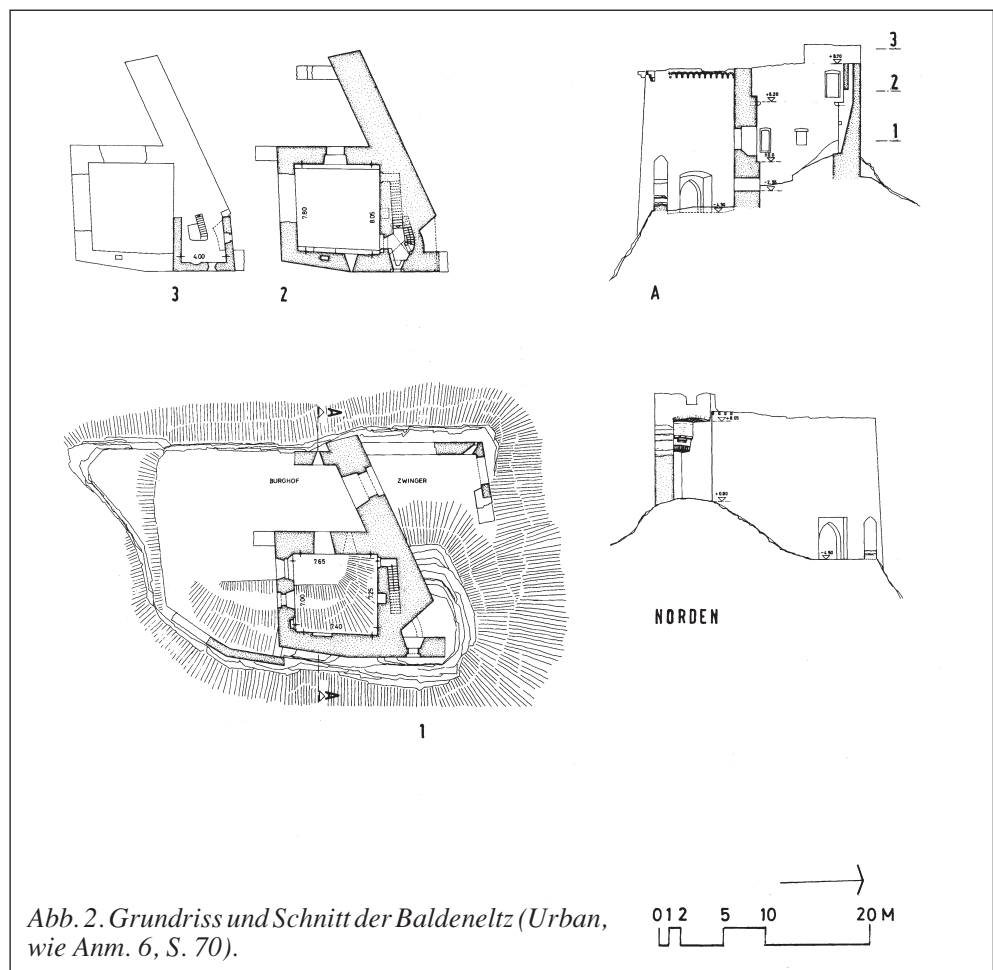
Grundriss und Schnitt der Baldeneltz (Urban, wie Anm. 6, S. 70).
